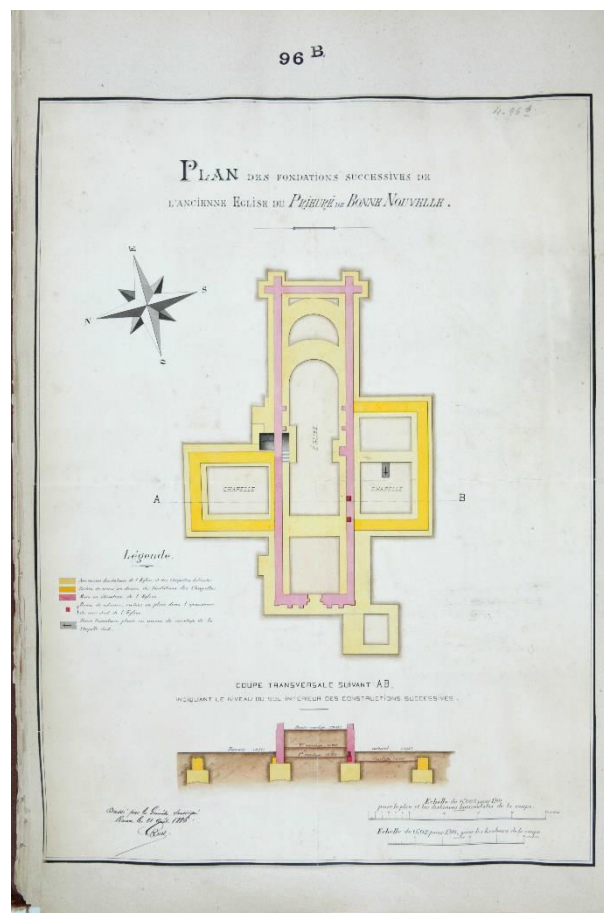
Église du prieuré de Notre-Dame-du-Pré, plan des fondations (A.D.S.M. 6 Fi 8).
